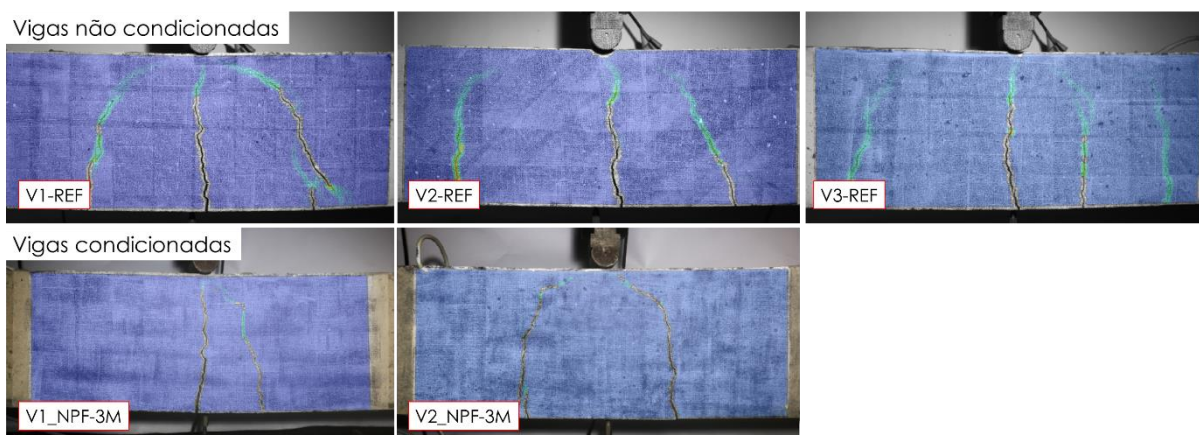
Comparação da fissuração das vigas na ruptura – vigas não pré-fissuras
